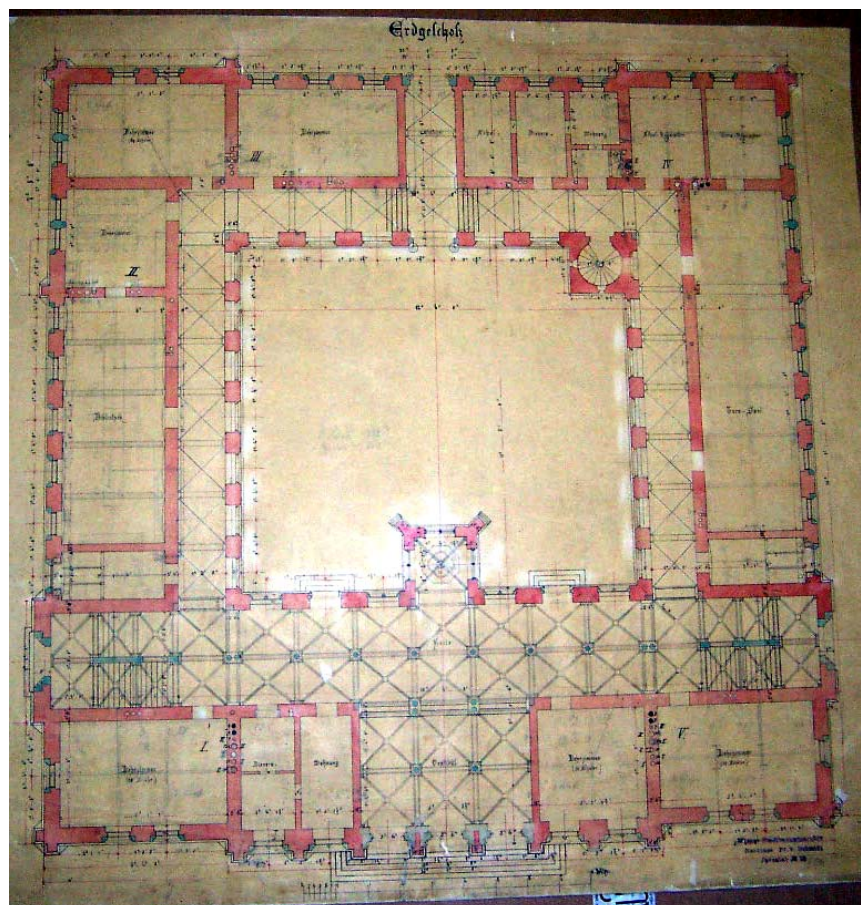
Grundrissplan, Erdgeschoss, nach 1862
